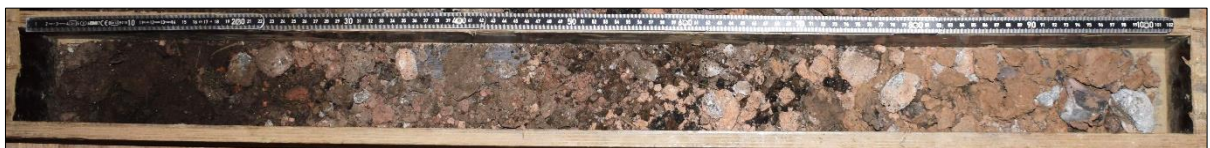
Erkundungsstelle BA1 – Bohrgut Kleinrammbohrung
